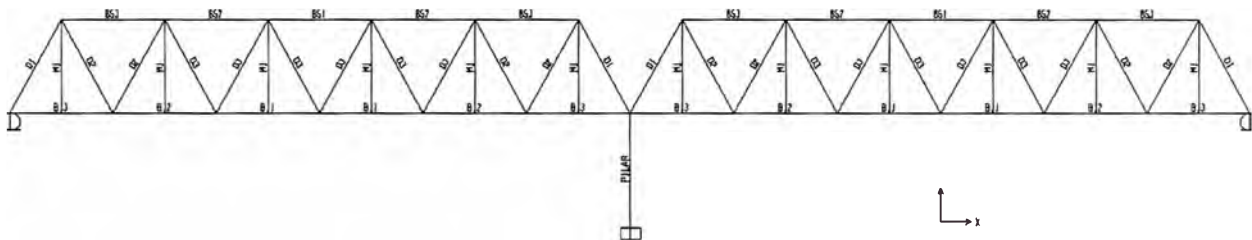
Modelamiento de la estructura y el pilar en el Programa Sap2000.
